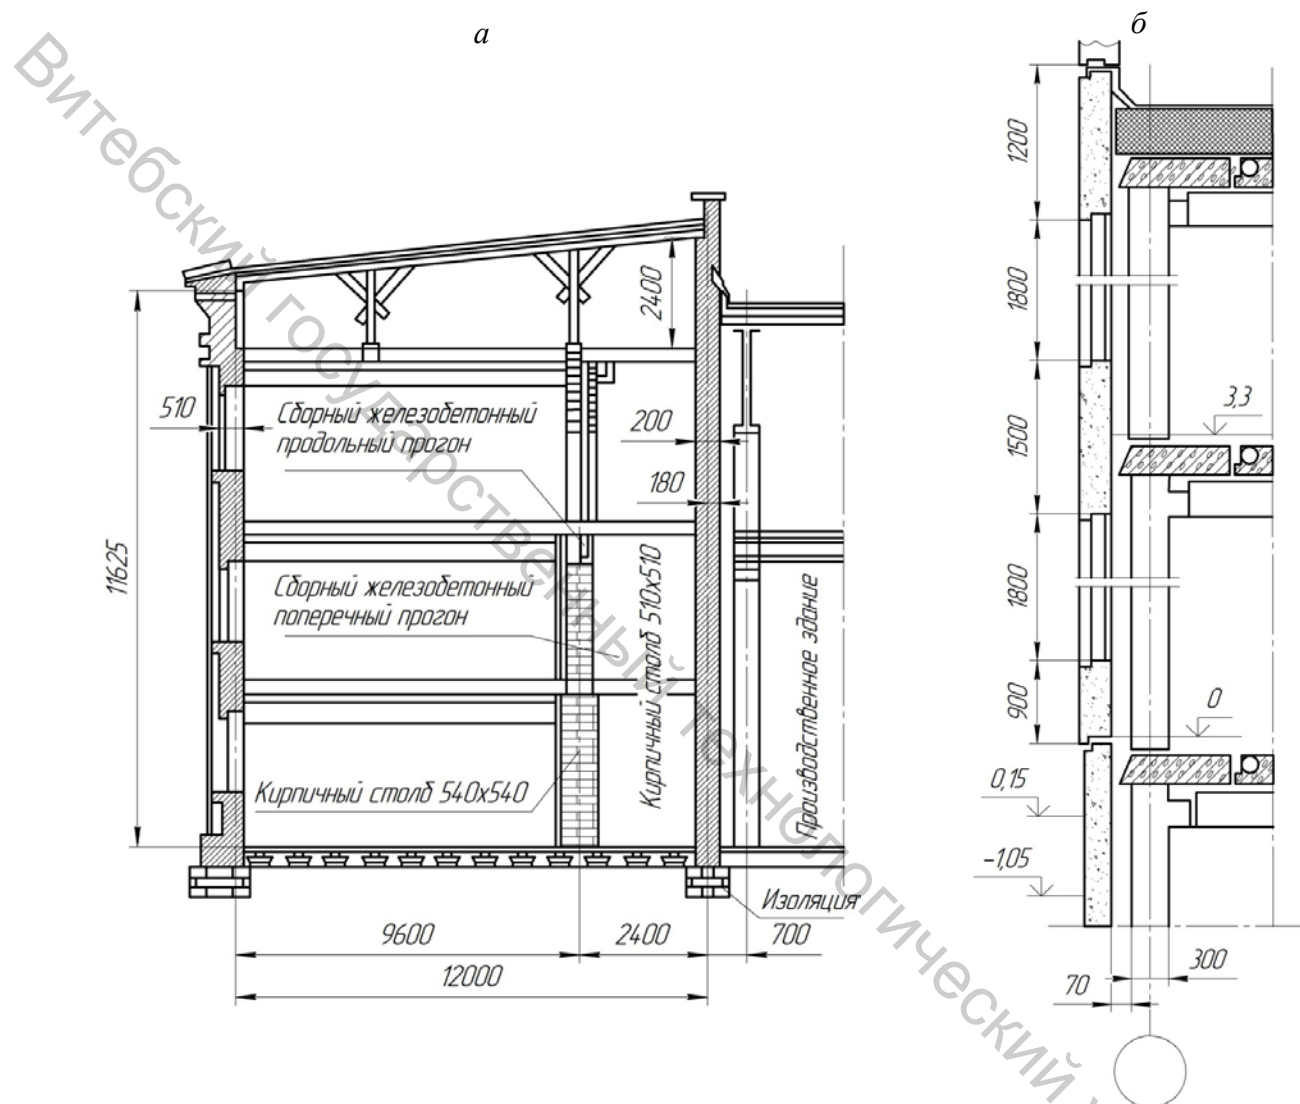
Поперечные разрезы конструкций здания административно-бытовых помещений: а – полный разрез обычной конструкции; б – разрез по наружной стене унифицированной конструкции
